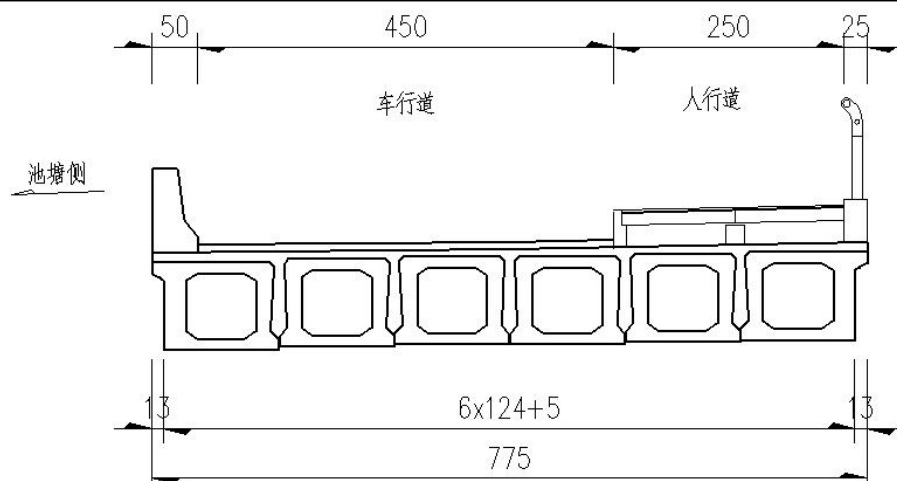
K0+77 桥梁横断面图 (单位: cm)
